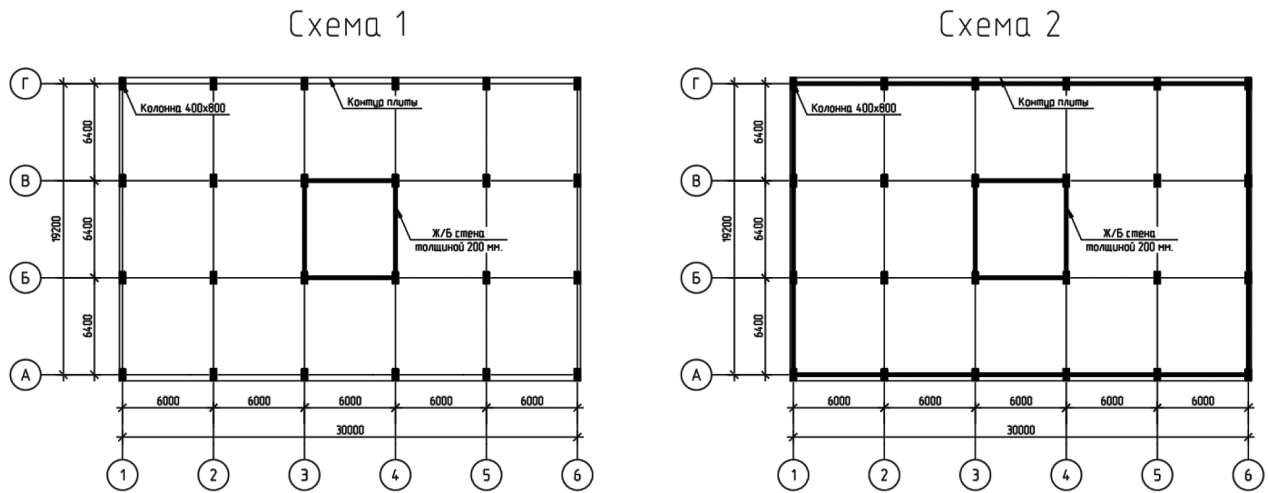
Схема 1- план несущих конструкций типового этажа обеих конструктивных систем.
